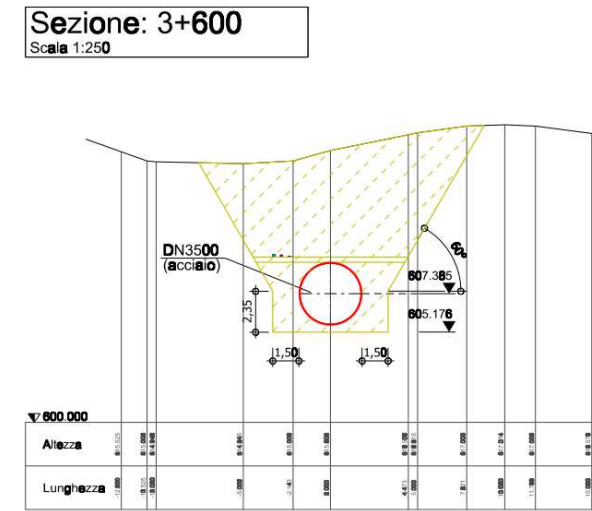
Sezione di posa della condotta forzata subito a monte del previsto attraversamento.
